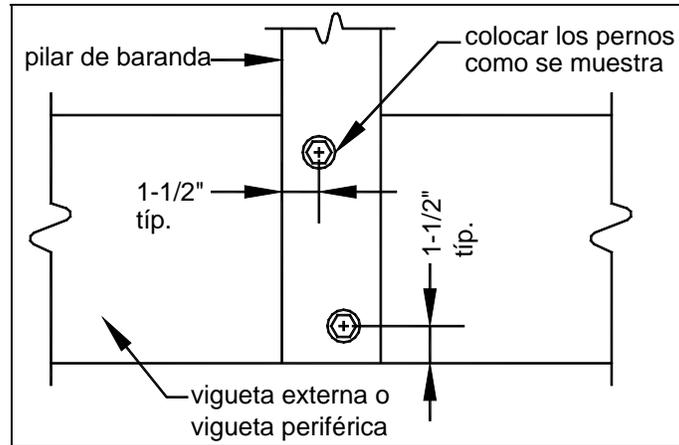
DETALLE SOBRE LA UNIÓN CON LOS PILARES DE LA BARANDA
